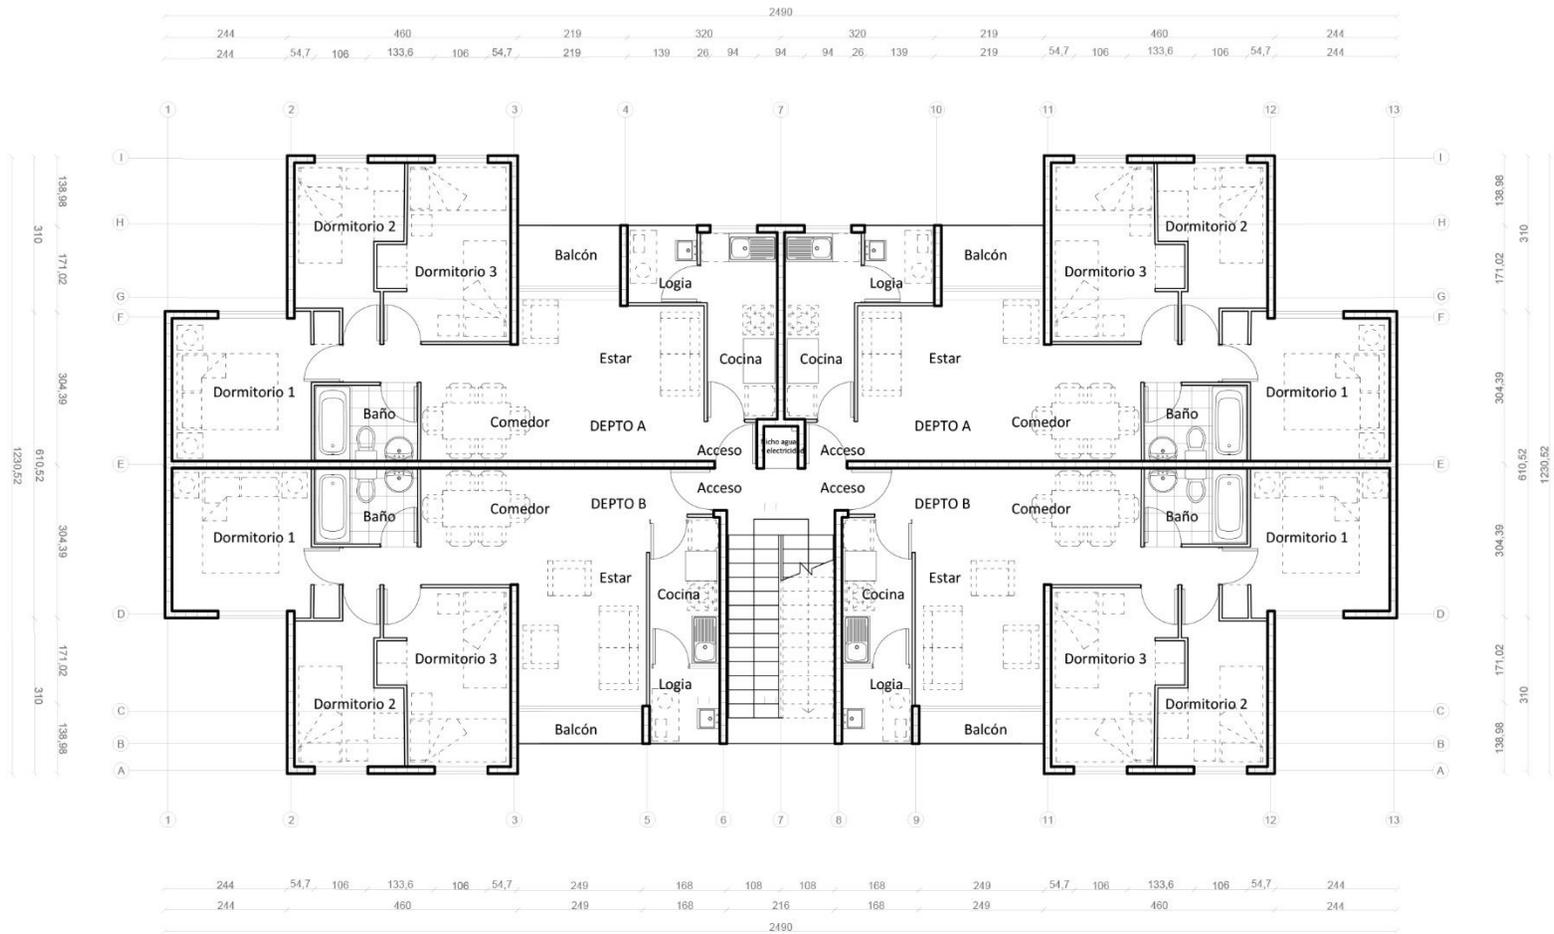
Plano piso Don Eduardo, escala 1:150. Fuente: Elaboración propia
